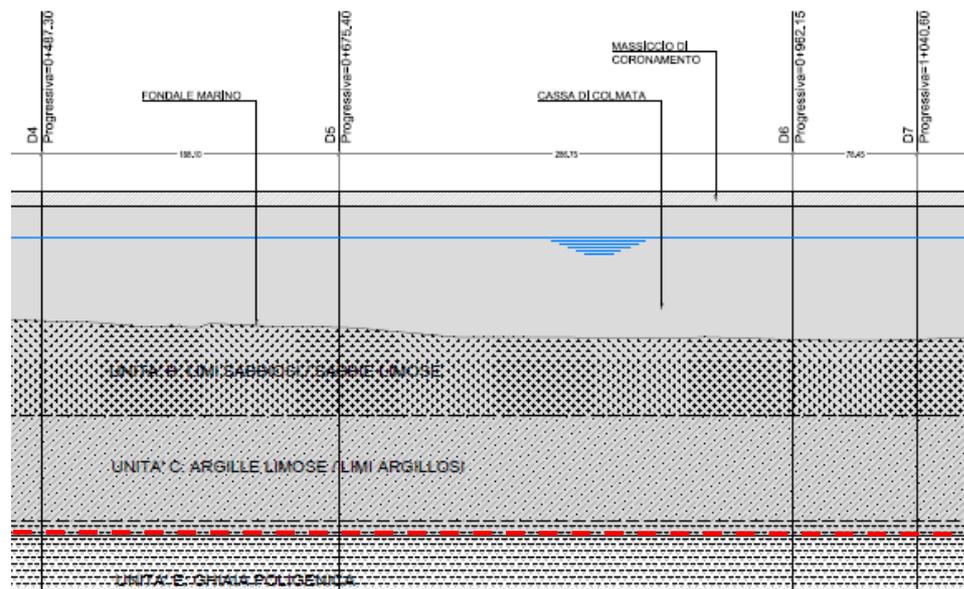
f: Diga Foranea - Prospetto Diaframma Plastico
